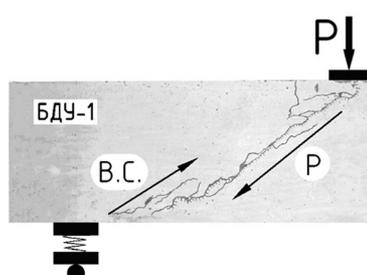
Схема разрушения и образования трещин (упруго опертый образец)
